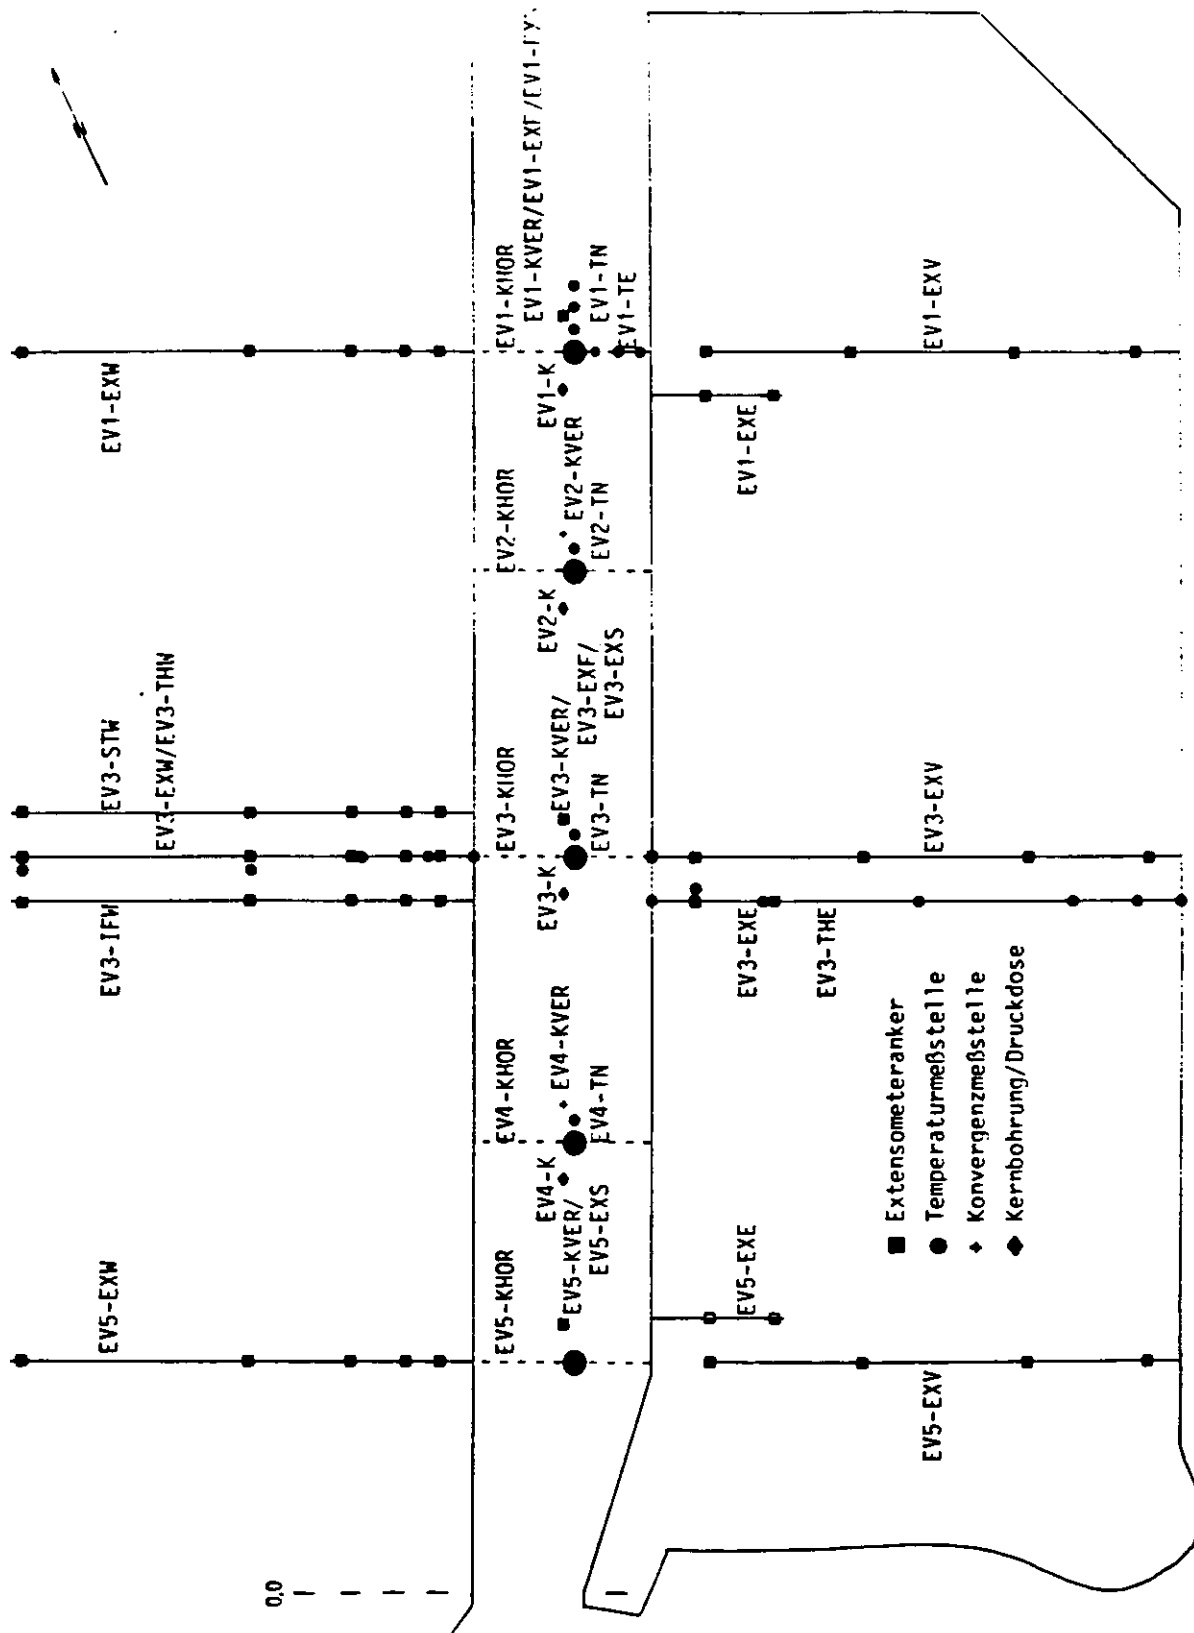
Grundriß der HAW-EV-Strecke mit geplanter geotechnischer Instrumentierung
